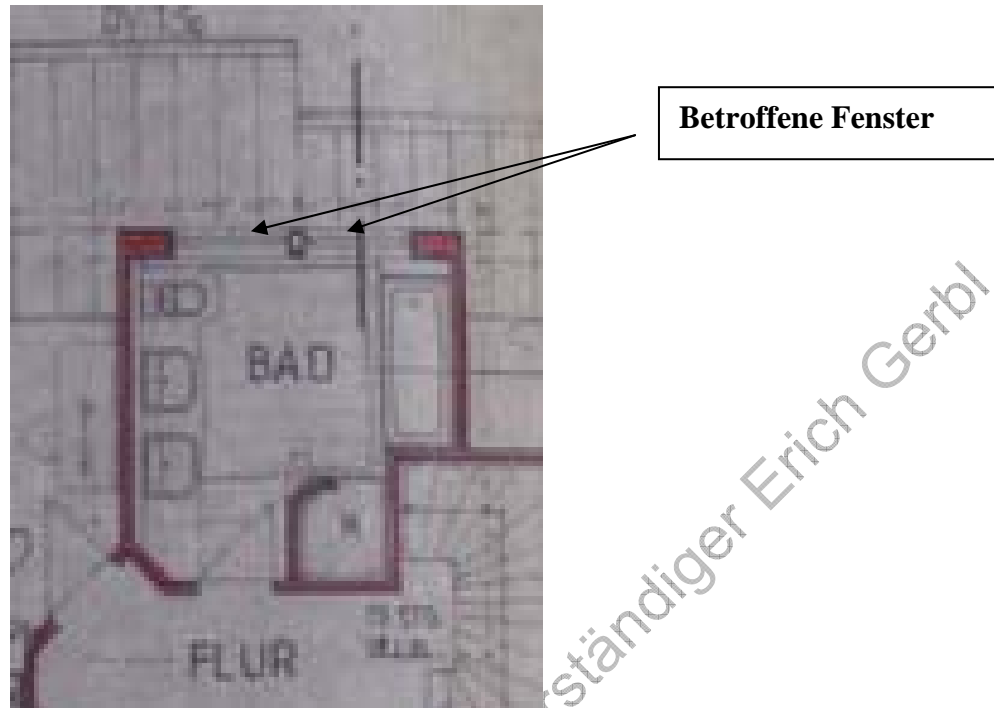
(Grundriss, Bad betroffene Fenster →)
